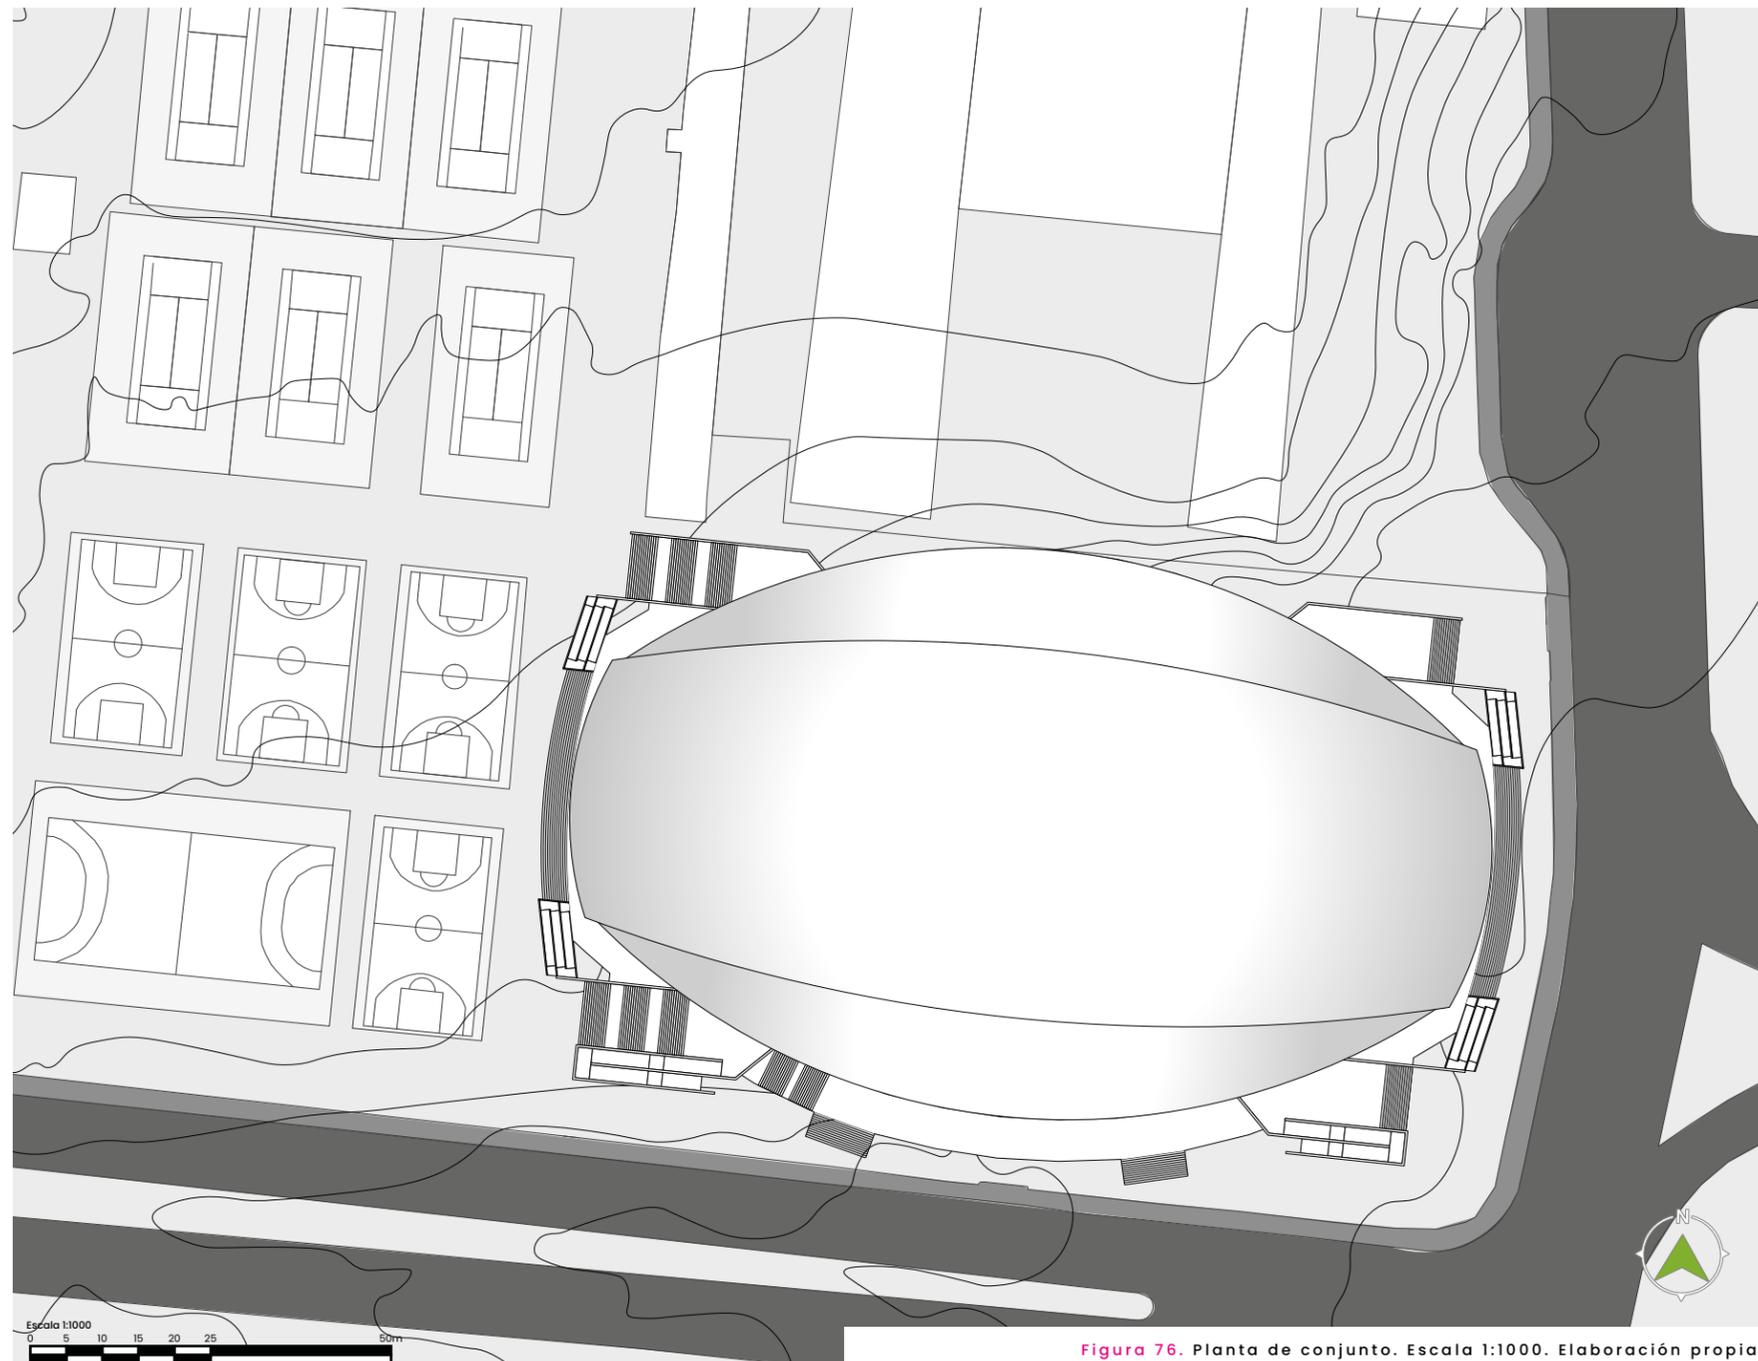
Planta de conjunto. Escala 1:1000. Elaboración propia.
